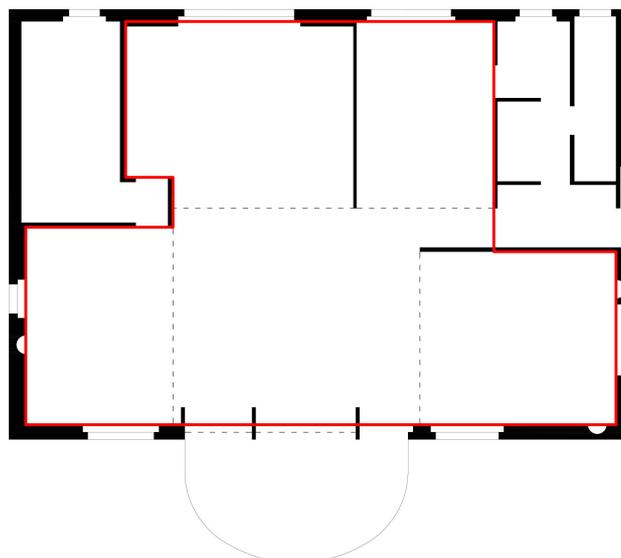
G. Ponti, casa adatta, schema di pianta 2 tipo C, 6 letti, 1970.
